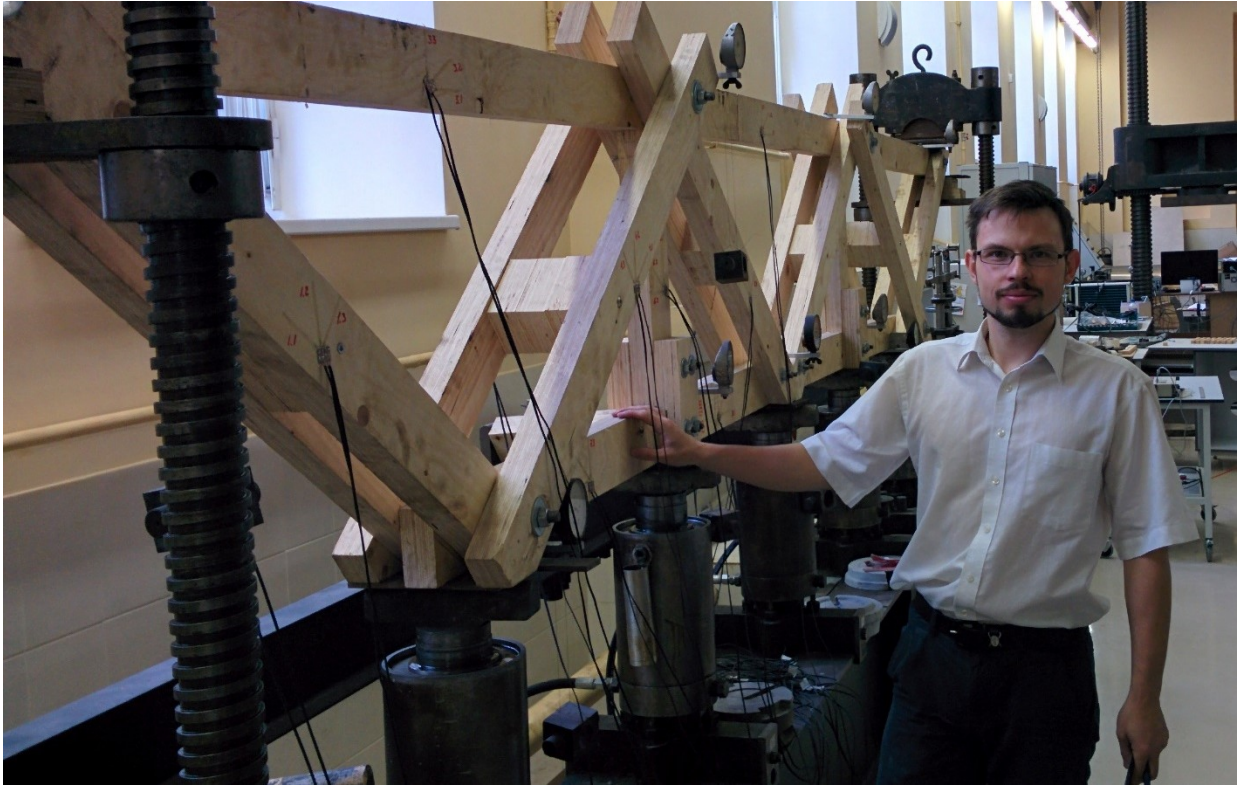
Испытуемая ферма до проведения испытаний.
